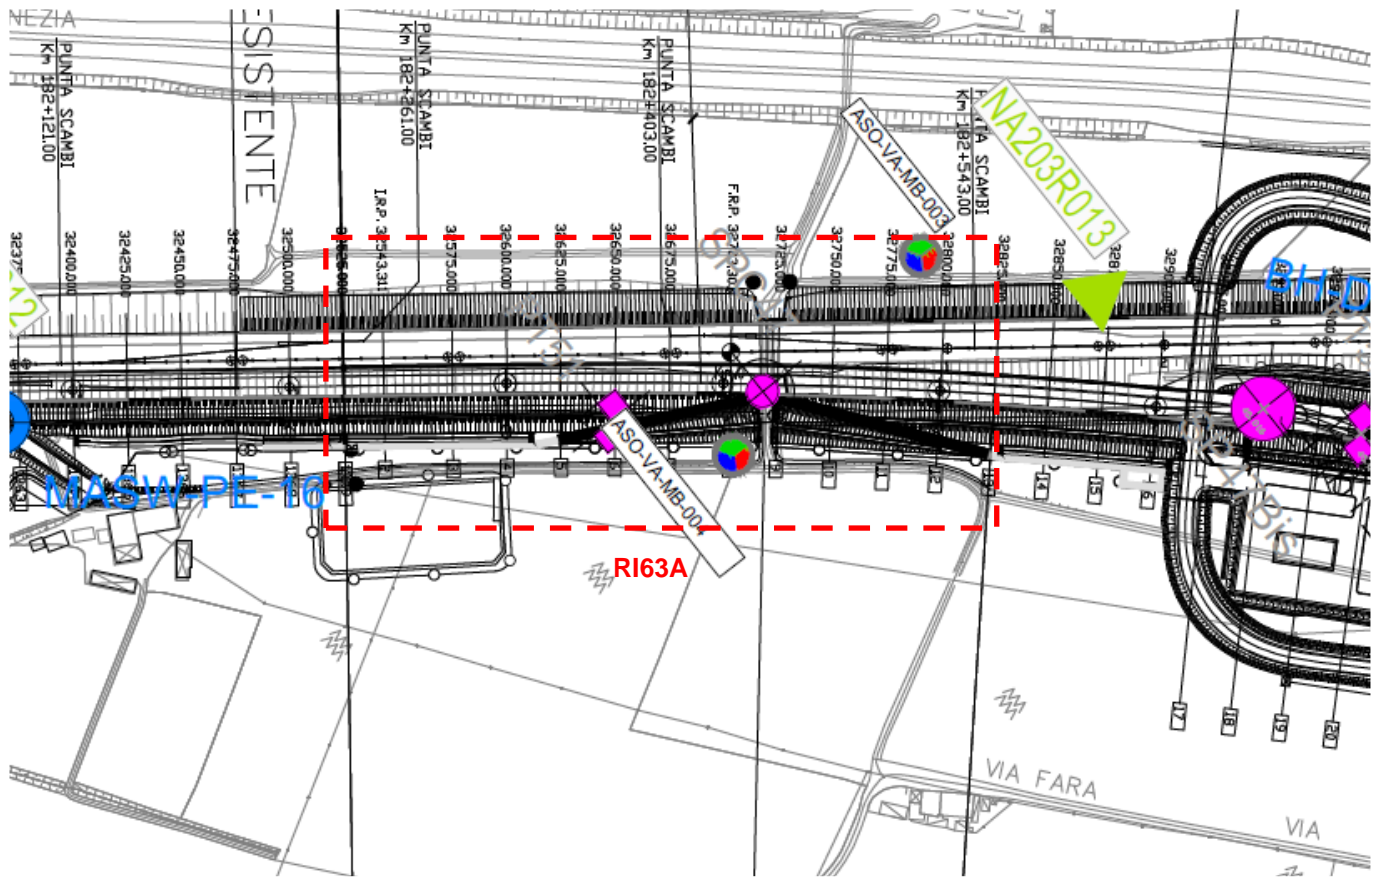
Planimetria Rilevato RI63a, estratto dalla Planimetria Generale (Doc. Rif.[6])
